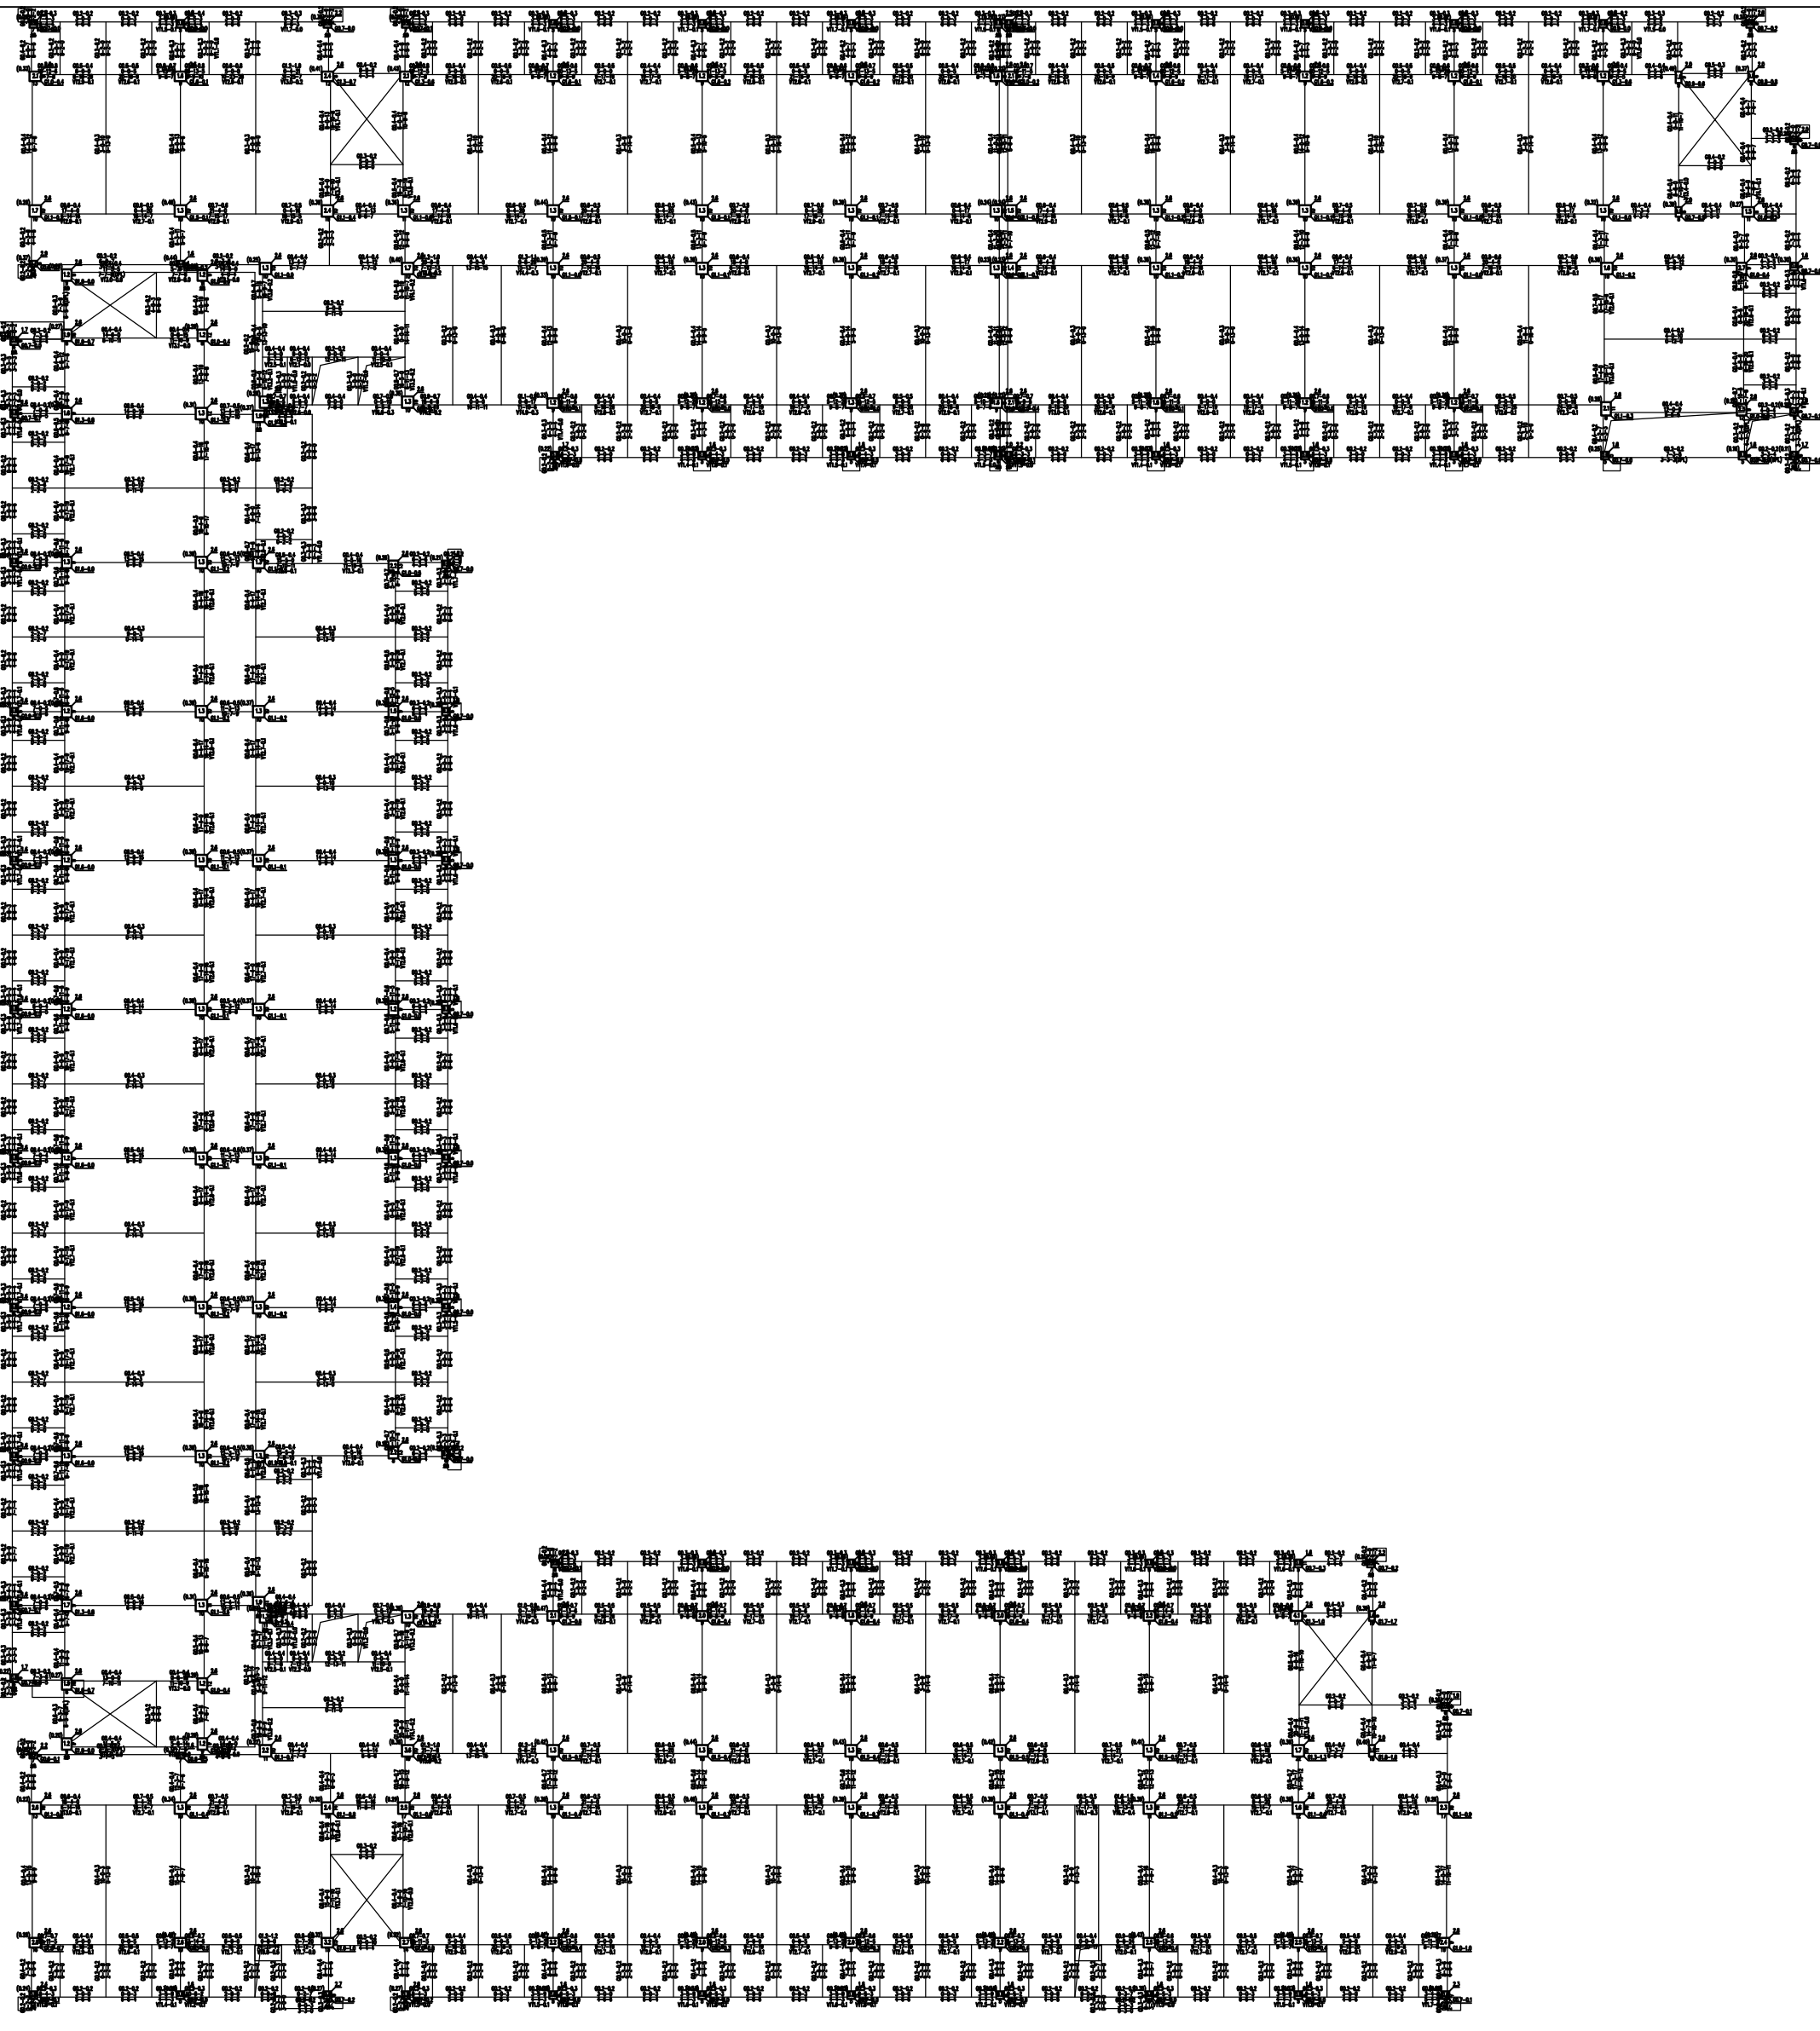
某工程(1) 楼上的板配筋平面图(单位:cm)
